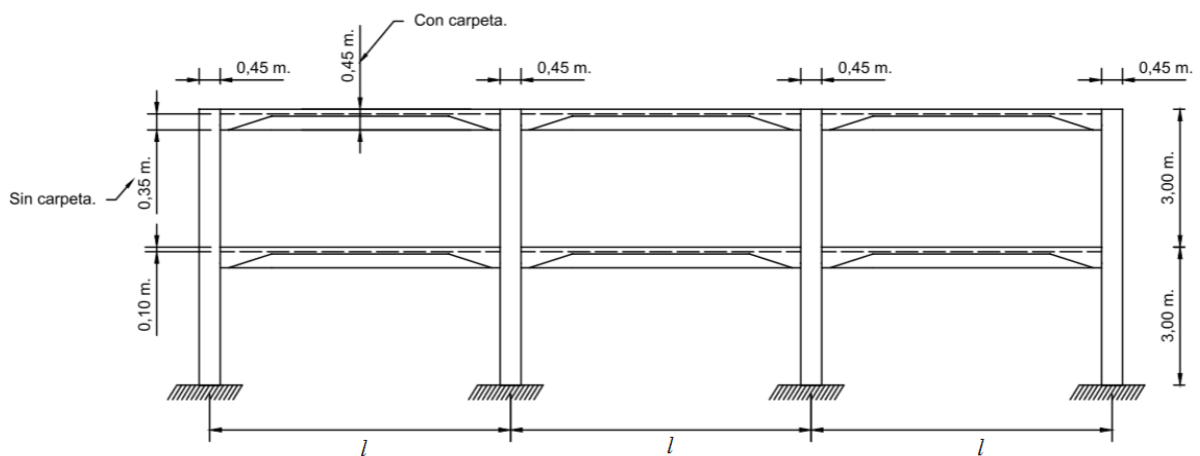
Pórtico conformado con Losas TT de sección variable más carpeta y muros.
